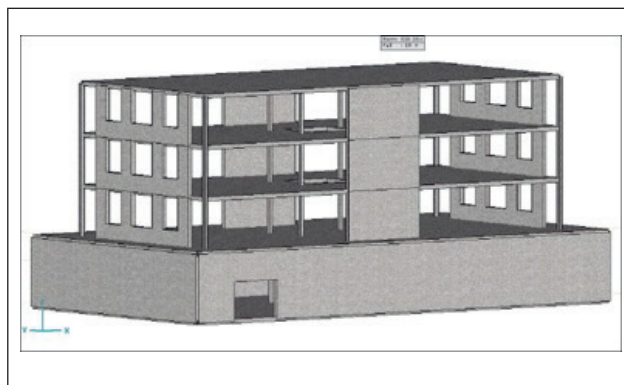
Betonscheiben mit Fensteröffnungen.
